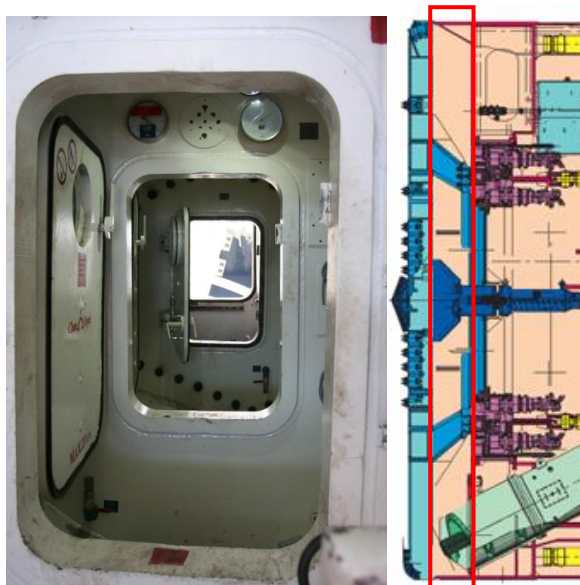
Particolare dell'ingresso e indicazione in sezione della camera di scavo [15]
